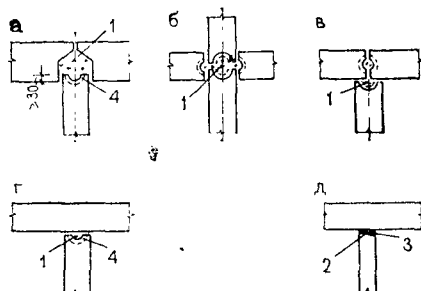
Звукоизоляция сопряжений панелей внутренних несущих стен
